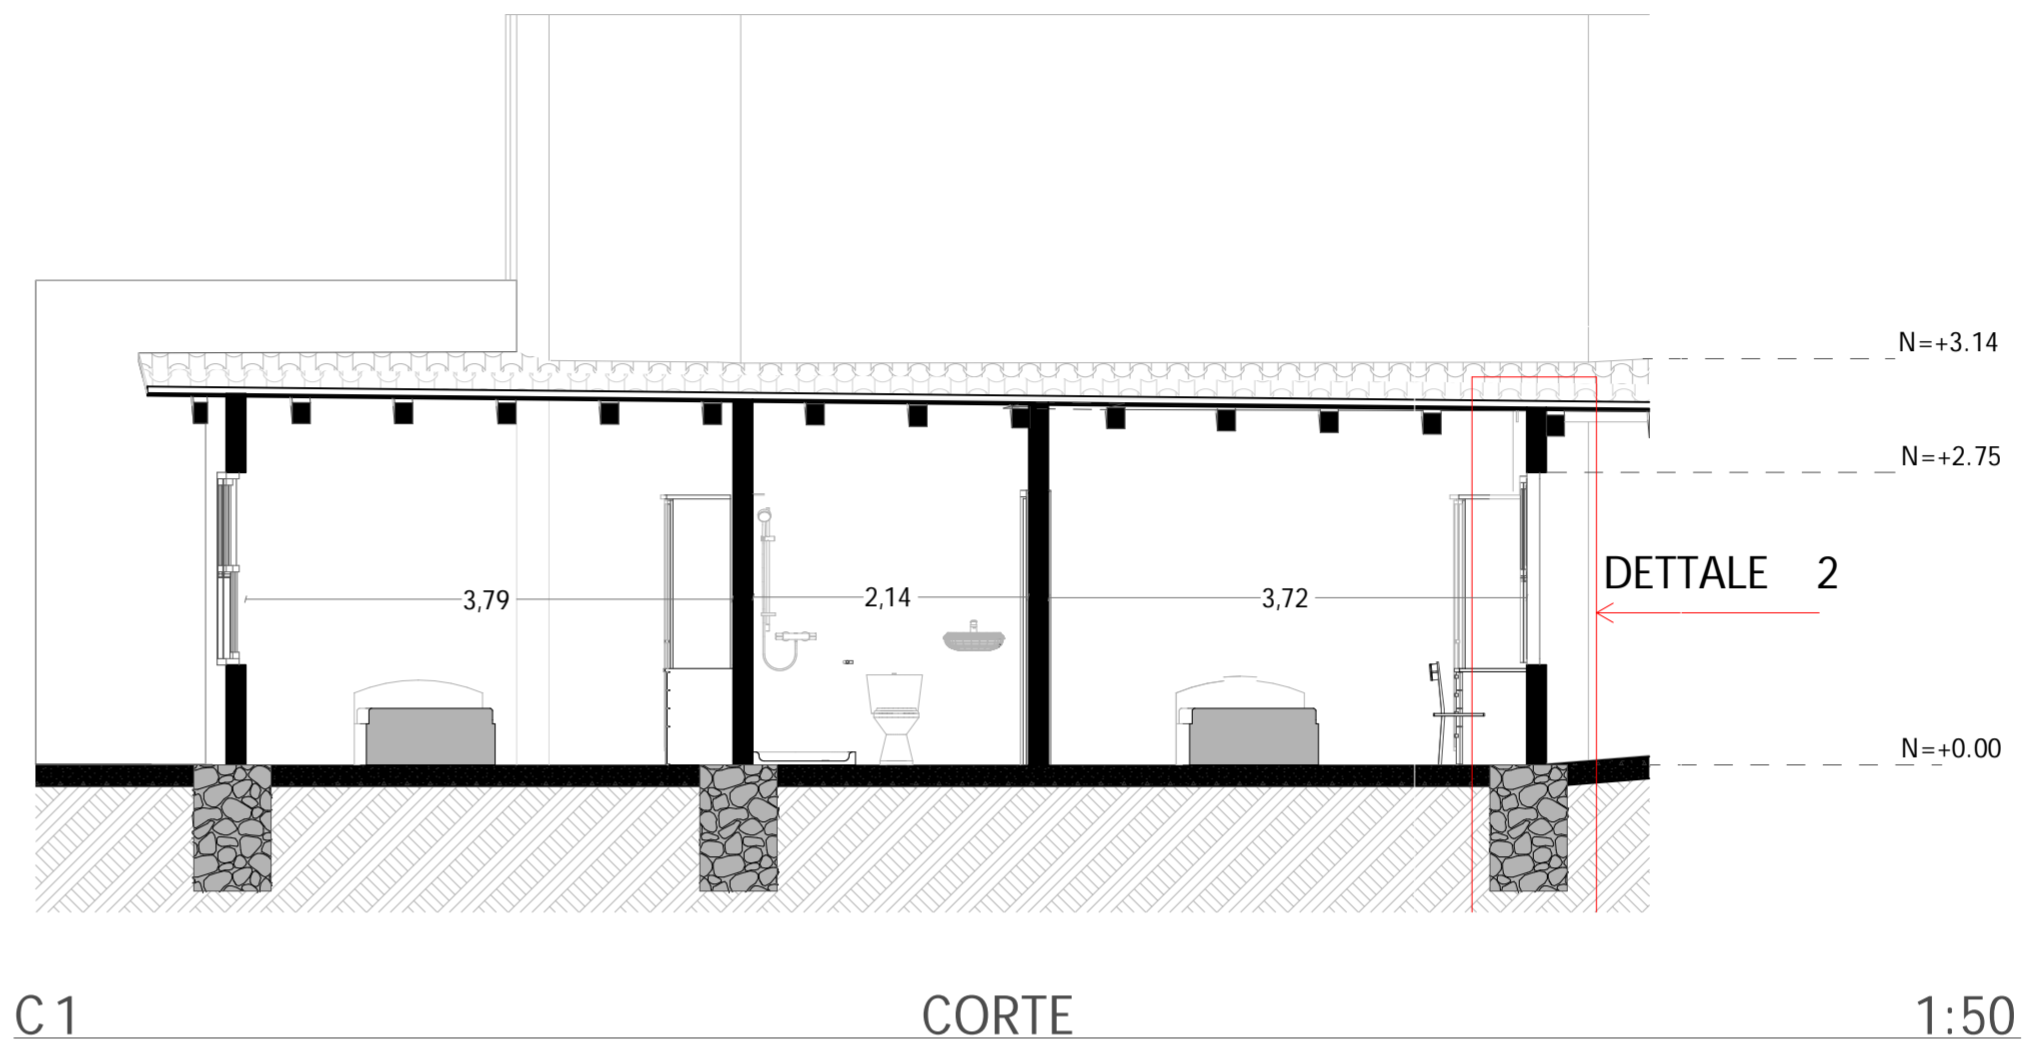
Cortes y detalle constructivo del bloque C del proyecto Casa Rodriguez
